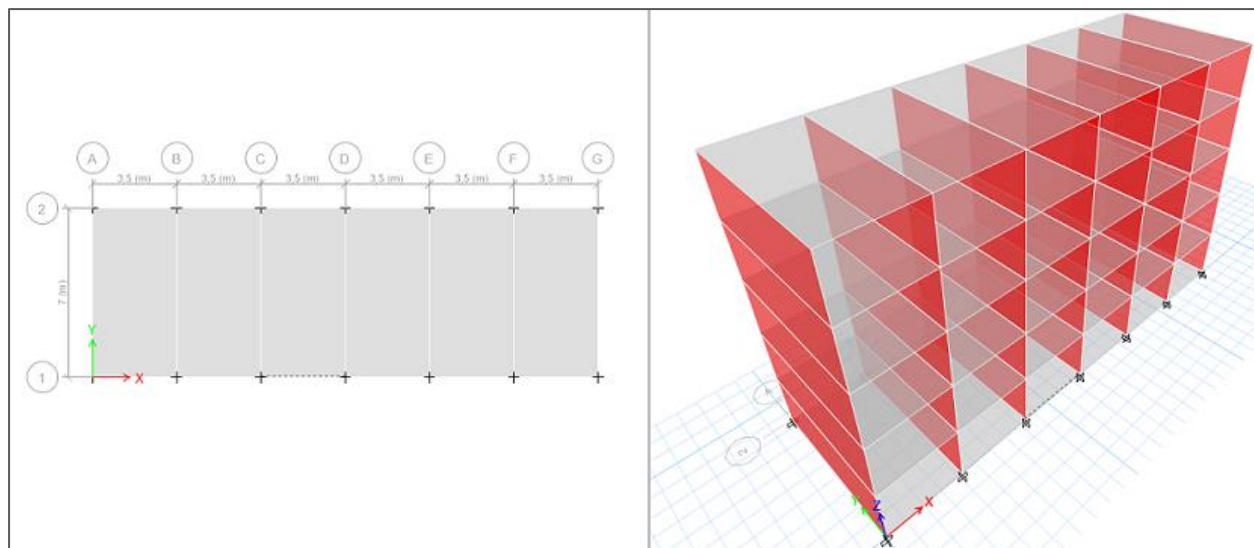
Vista en planta y vista 3D del edificio modelo. Fuente: Propia.
